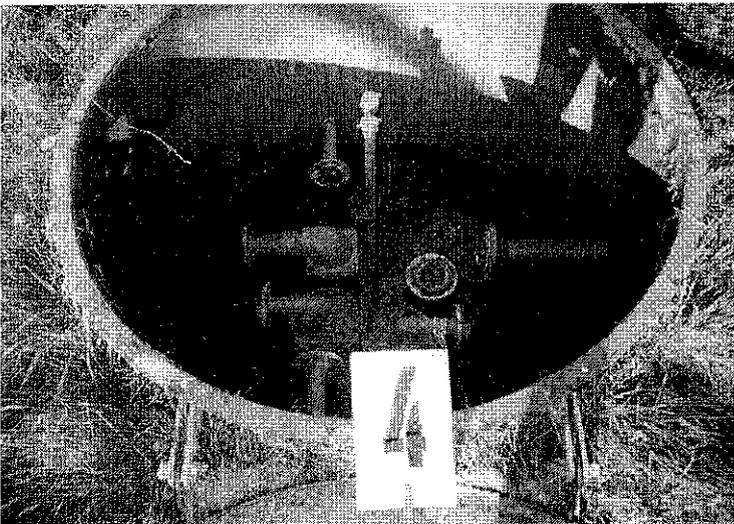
Domschacht am östlichen Tankende Erdtank 1; Tankdeckel geschlossen; Leitungen verschlossen; in Domschacht steht Wasser; Aufnahme vom 13.11.01
